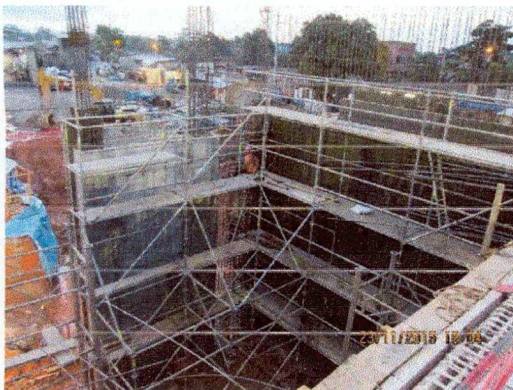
Se observa desencofrado de placa y el acabado caravista.
